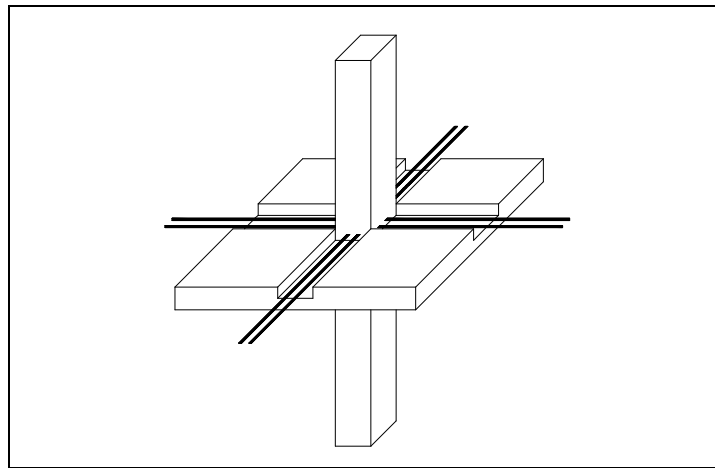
Ligação laje-pilar pós-tensionada (Paradigm)
